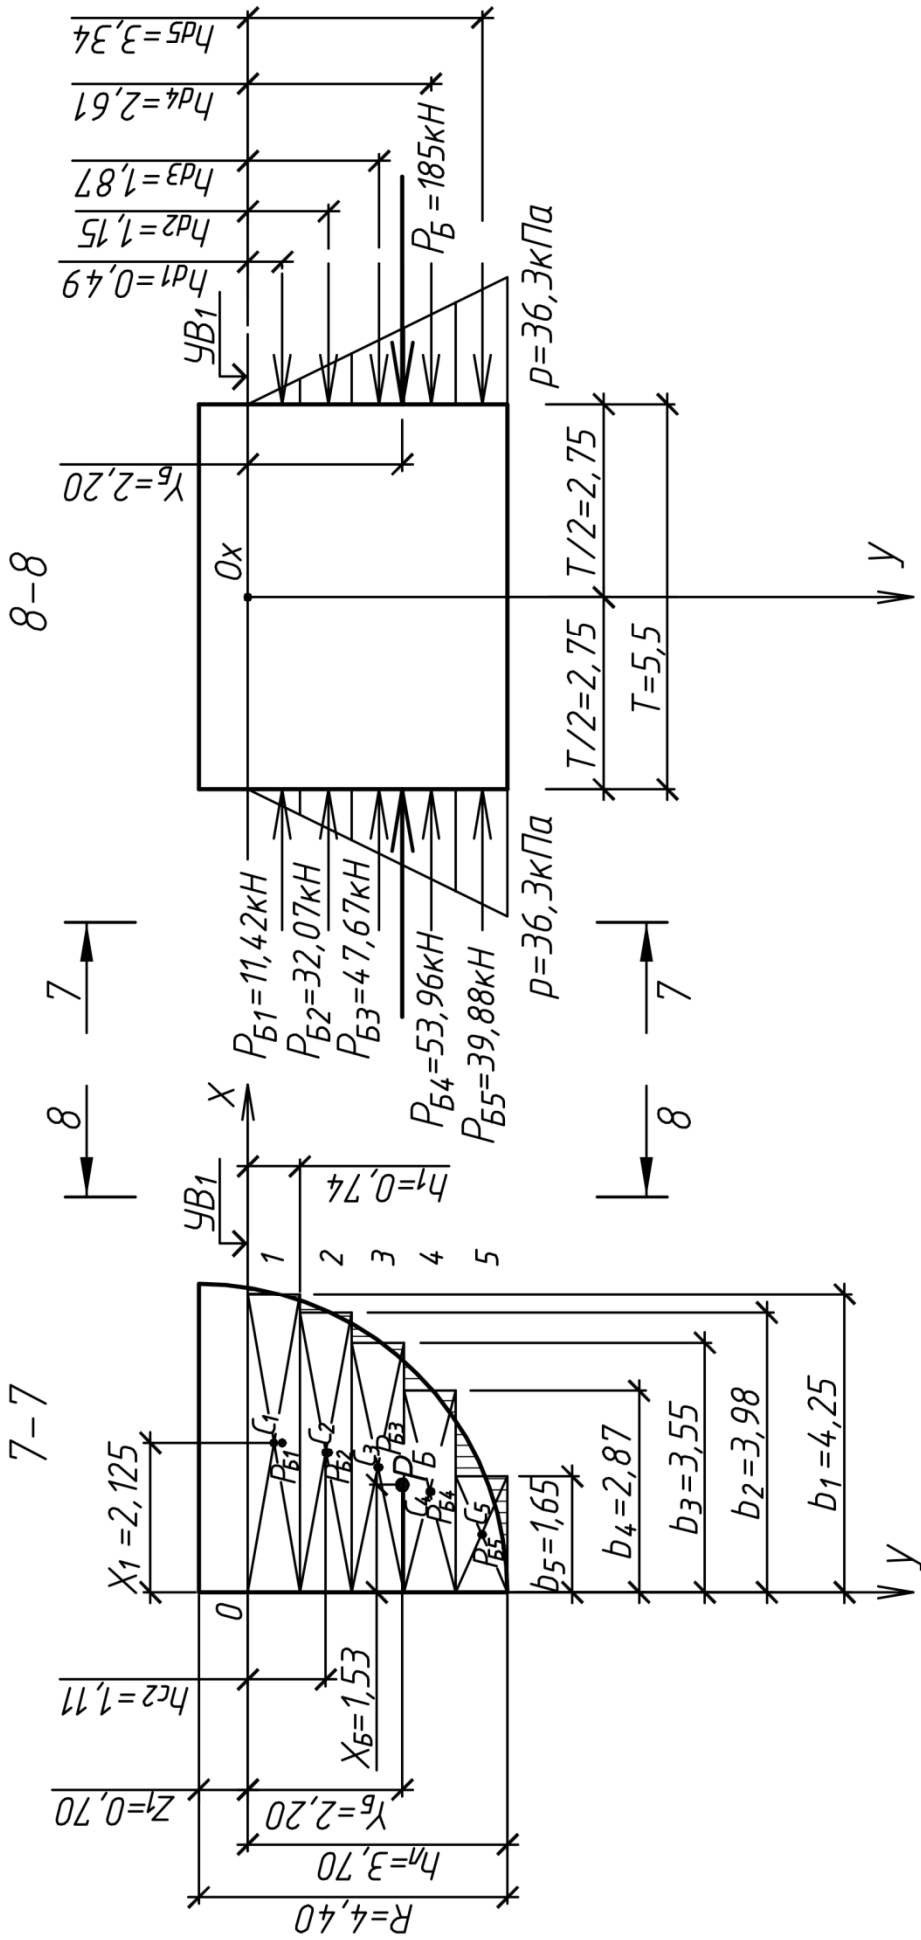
Схема к расчету носовой части с нагрузками на боковые стенки
